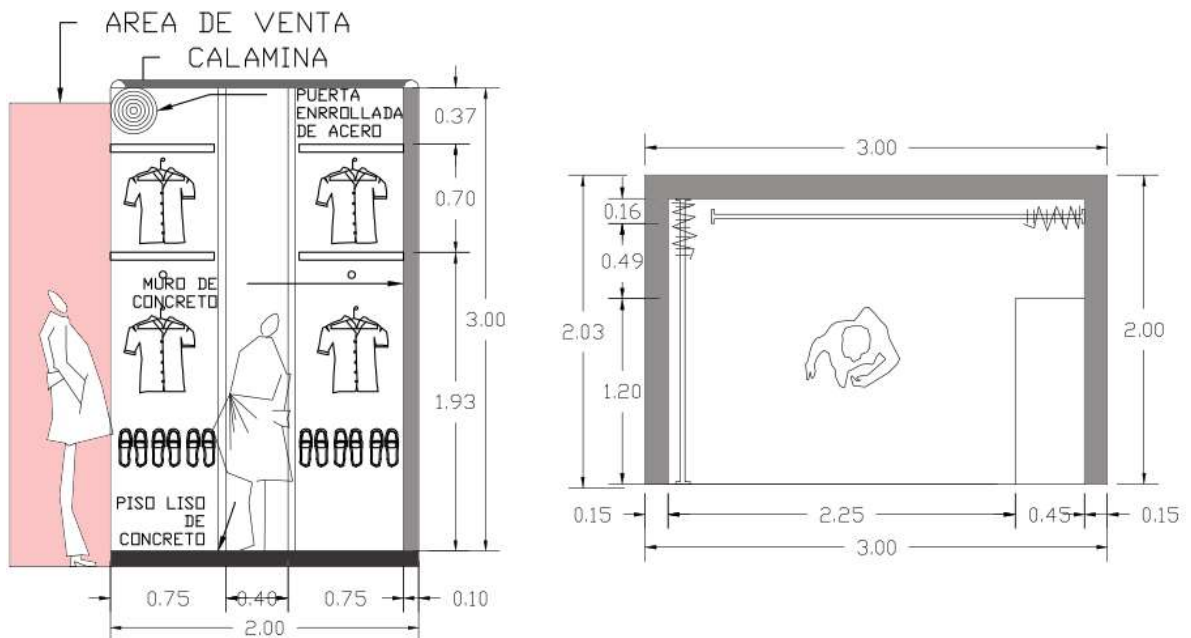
Corte Detallado y Planta del Puesto de Ropa y Joyería / Elaboración propia
